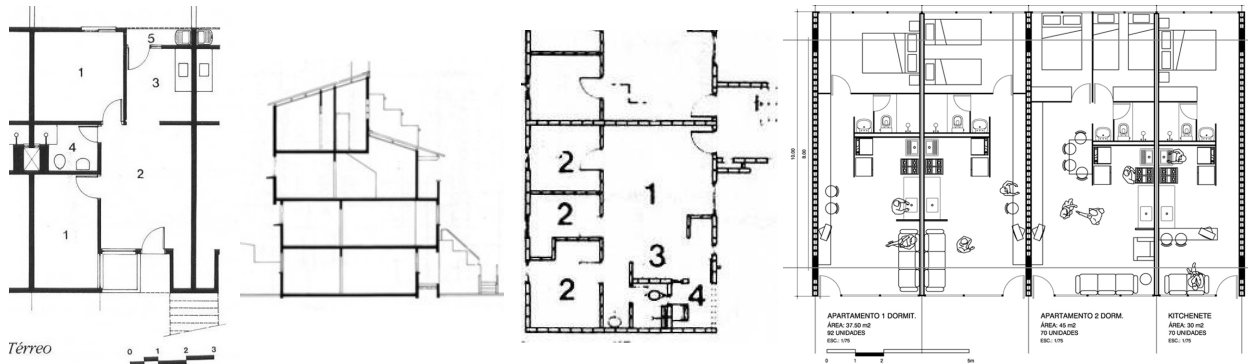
Planta tipo e corte do projeto Rincão (VB-03); Planta tipo do projeto Minas Gás (VB-06). Planta tipo do projeto Habitasampa Barra Funda (VB-01).
